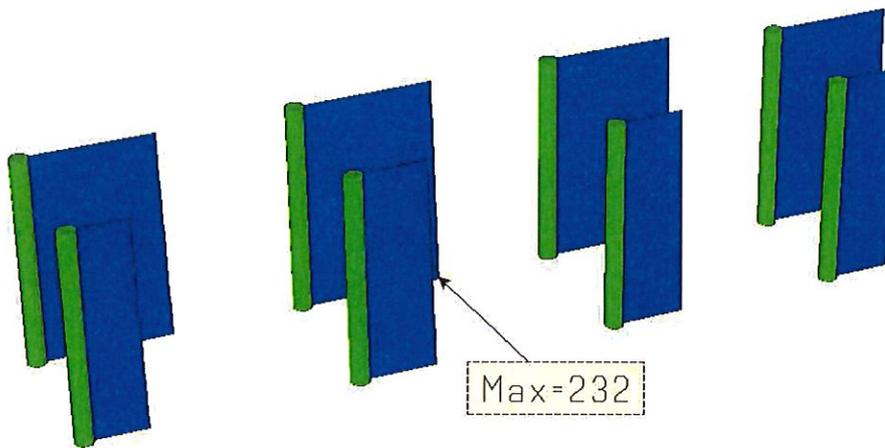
Sforzo normale di compressione pilastri circolari in c.a. [kN]
